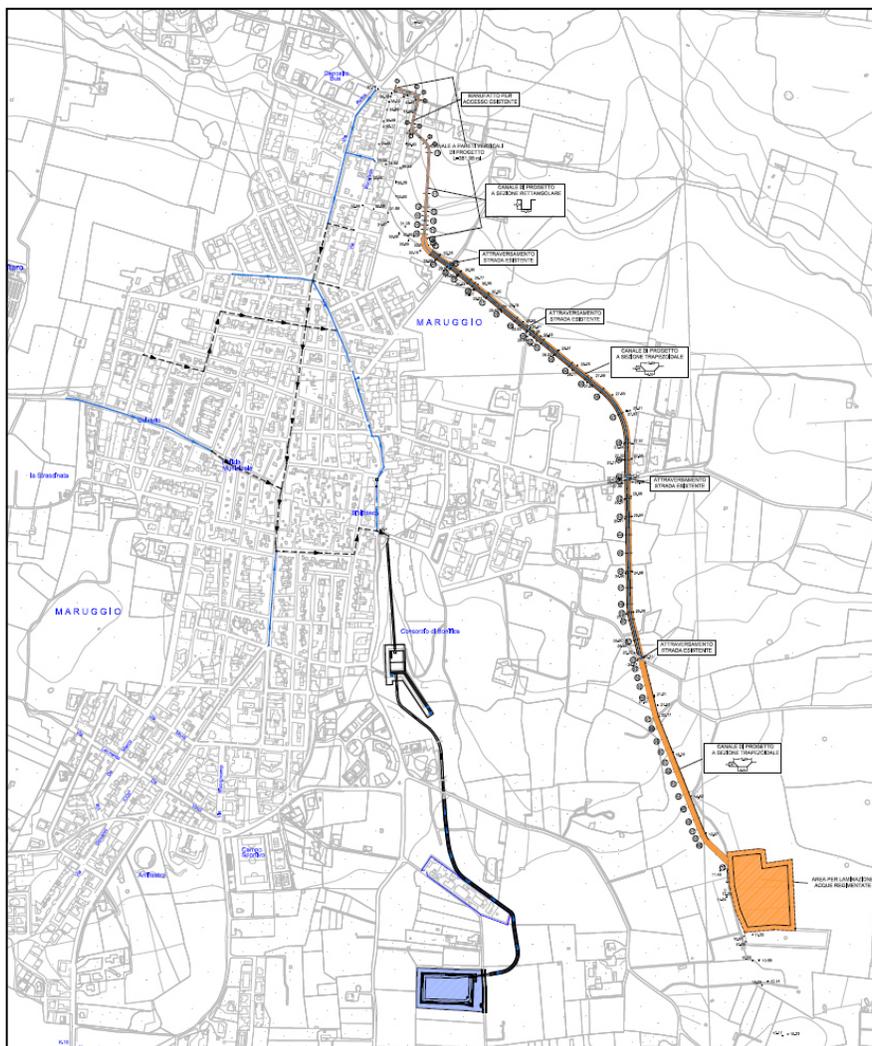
Planimetria (in arancione) degli interventi previsti dall'alternativa 1
